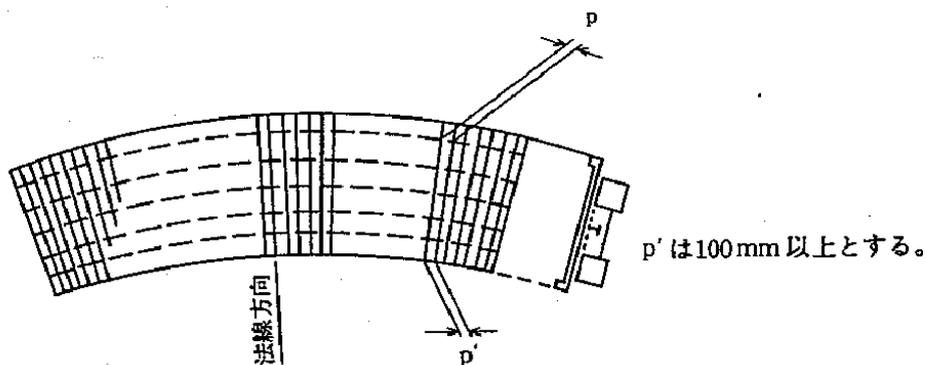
主鉄筋の配筋方向 (支承線が法線方向と一致する曲線橋の場合)
